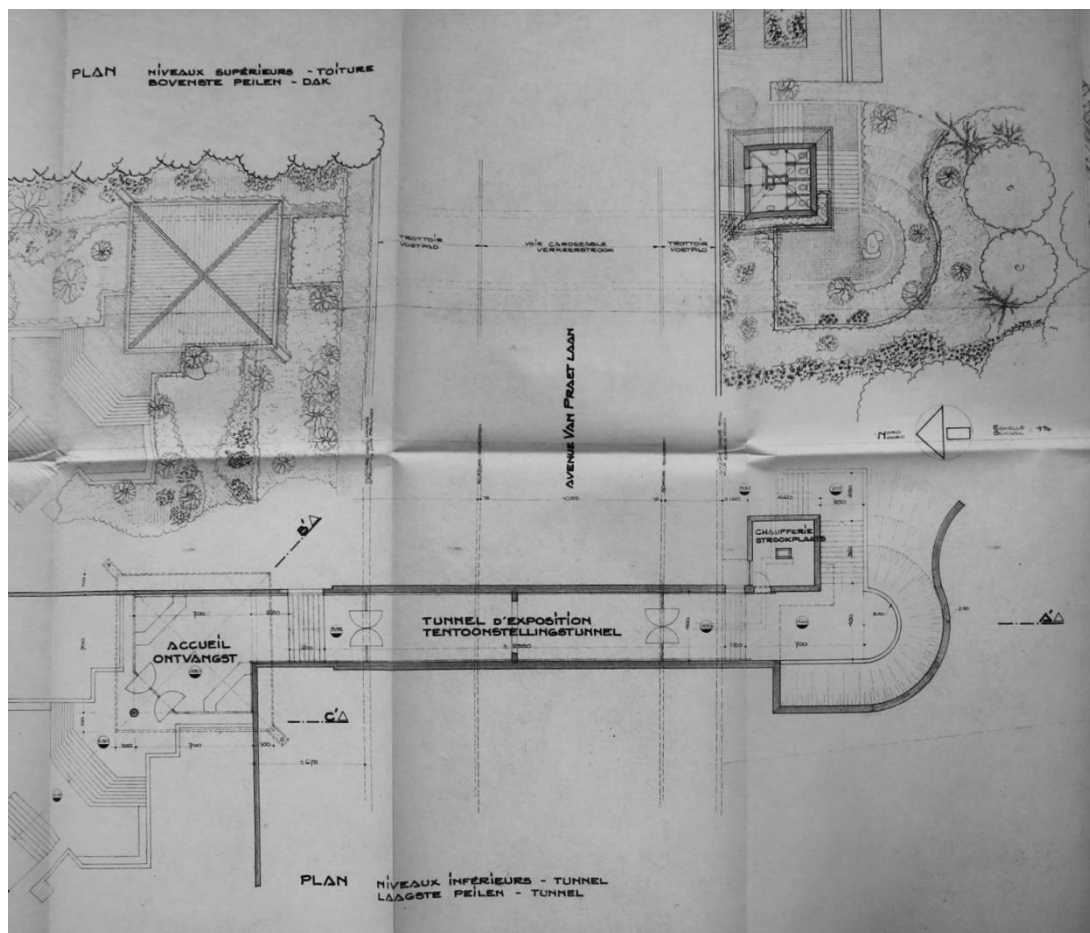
Plans de liaison piétonne en tunnel et pavillons d'accueil ©Archives d'Urban.brussels
